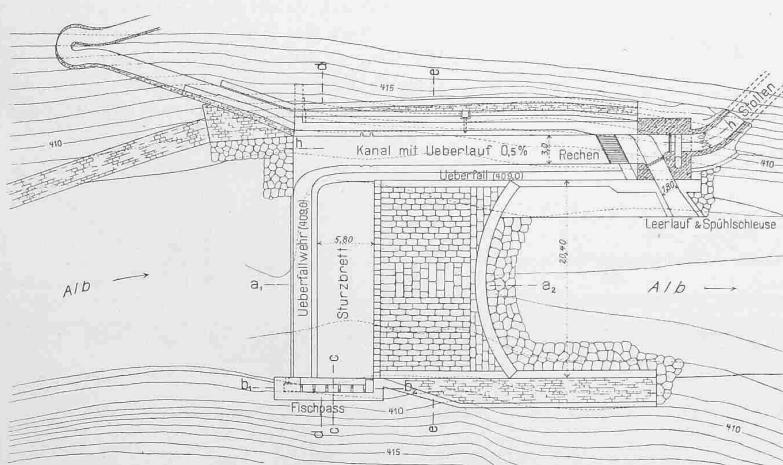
Grundriss der Wehranlage. — Masstab 1:700.
